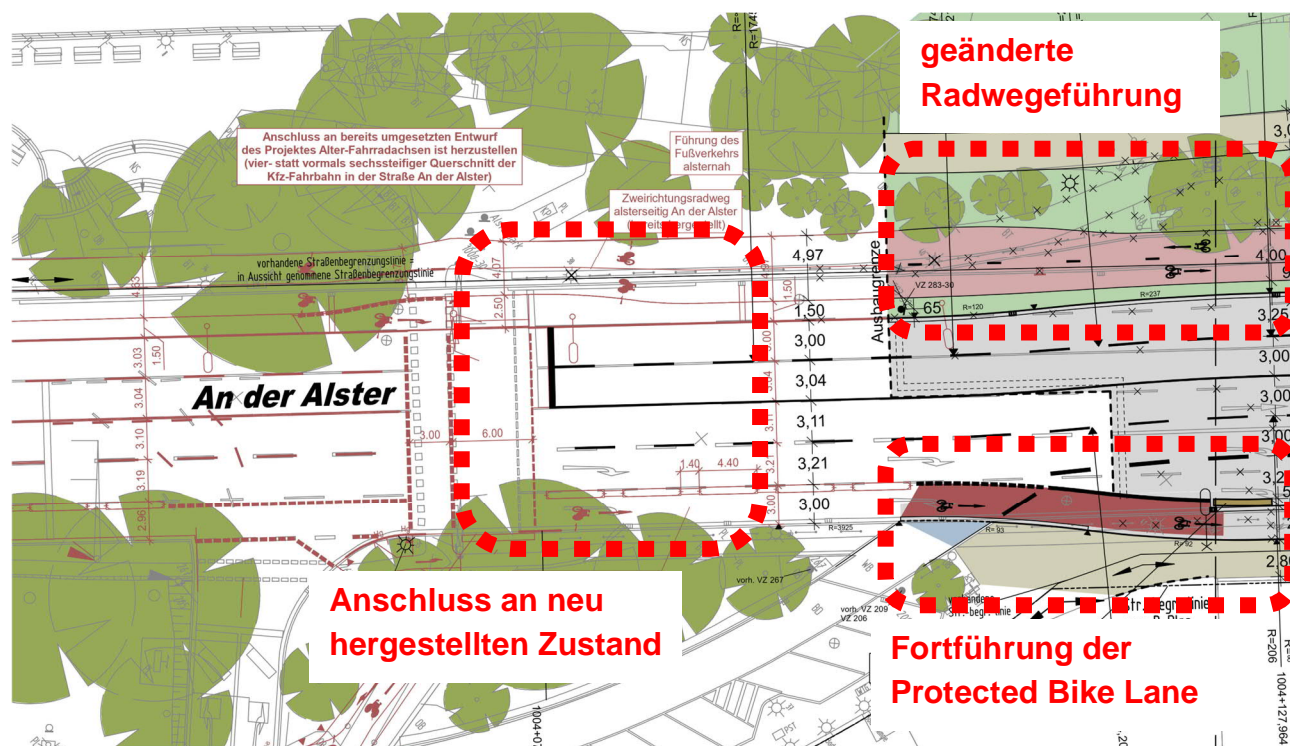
Lageplan-Ausschnitt An der Alster, Anschluss an Knotenpunkt Lohmühlenstraße
